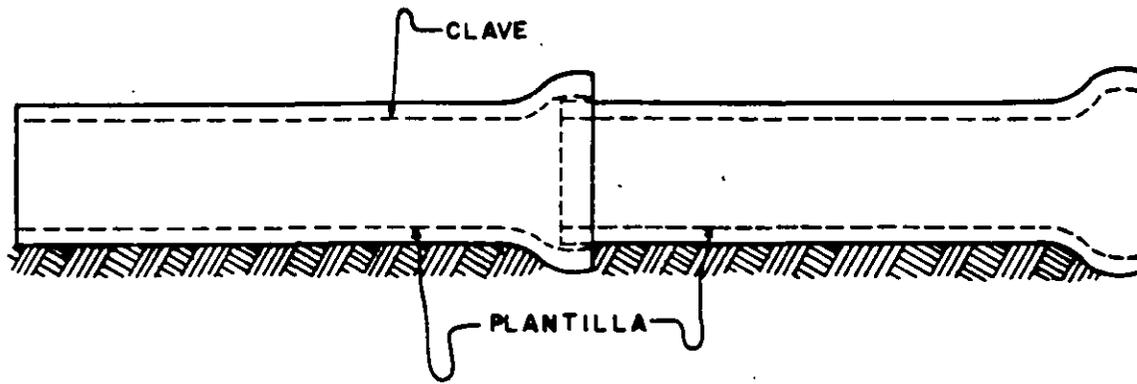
UNION MACHO CAMPANA EN TUBERIAS DE CONCRETO SIMPLE
